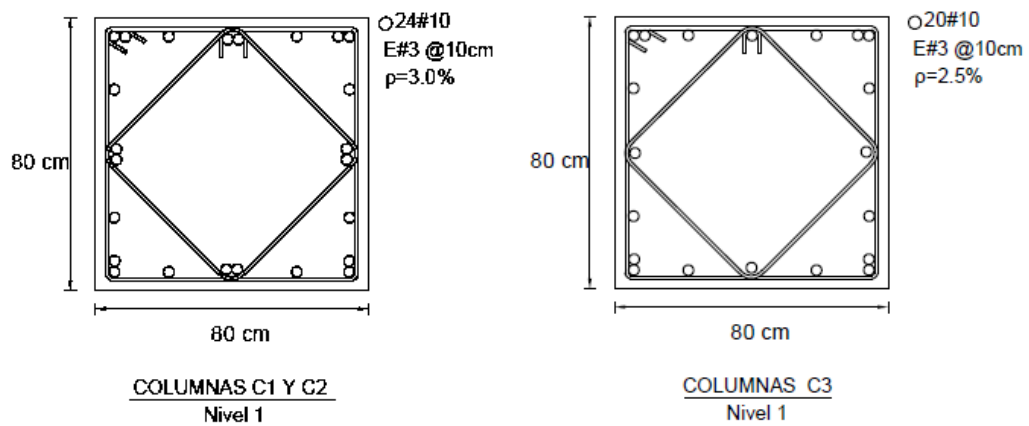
Armado de vigas y columnas diseñadas con las NTCC-04 para el edificio de 4 niveles con un sistema estructural a base de marcos dúctiles
